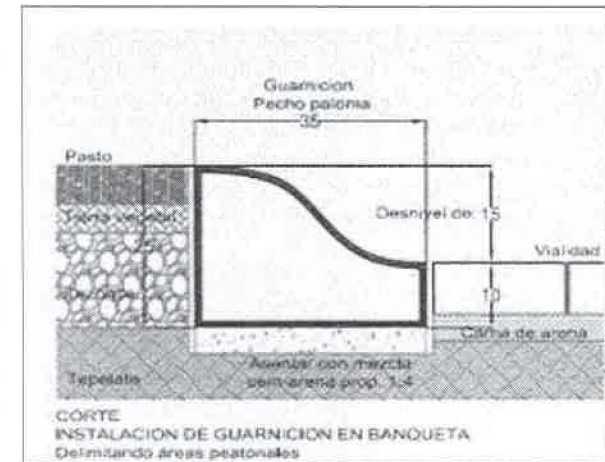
Detalle de fabricación de guarnición pecho de paloma de Concreto.
